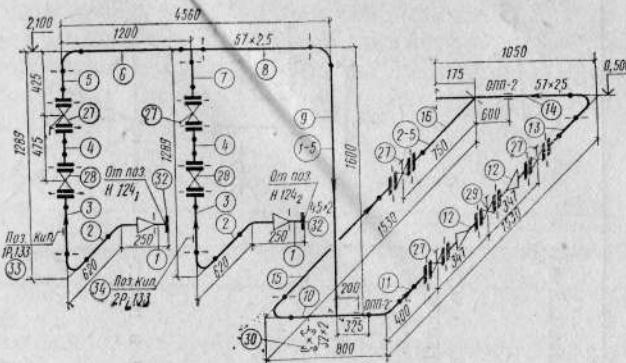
Монтажно-сборочная схема трубопровода с разбивкой на элементы
